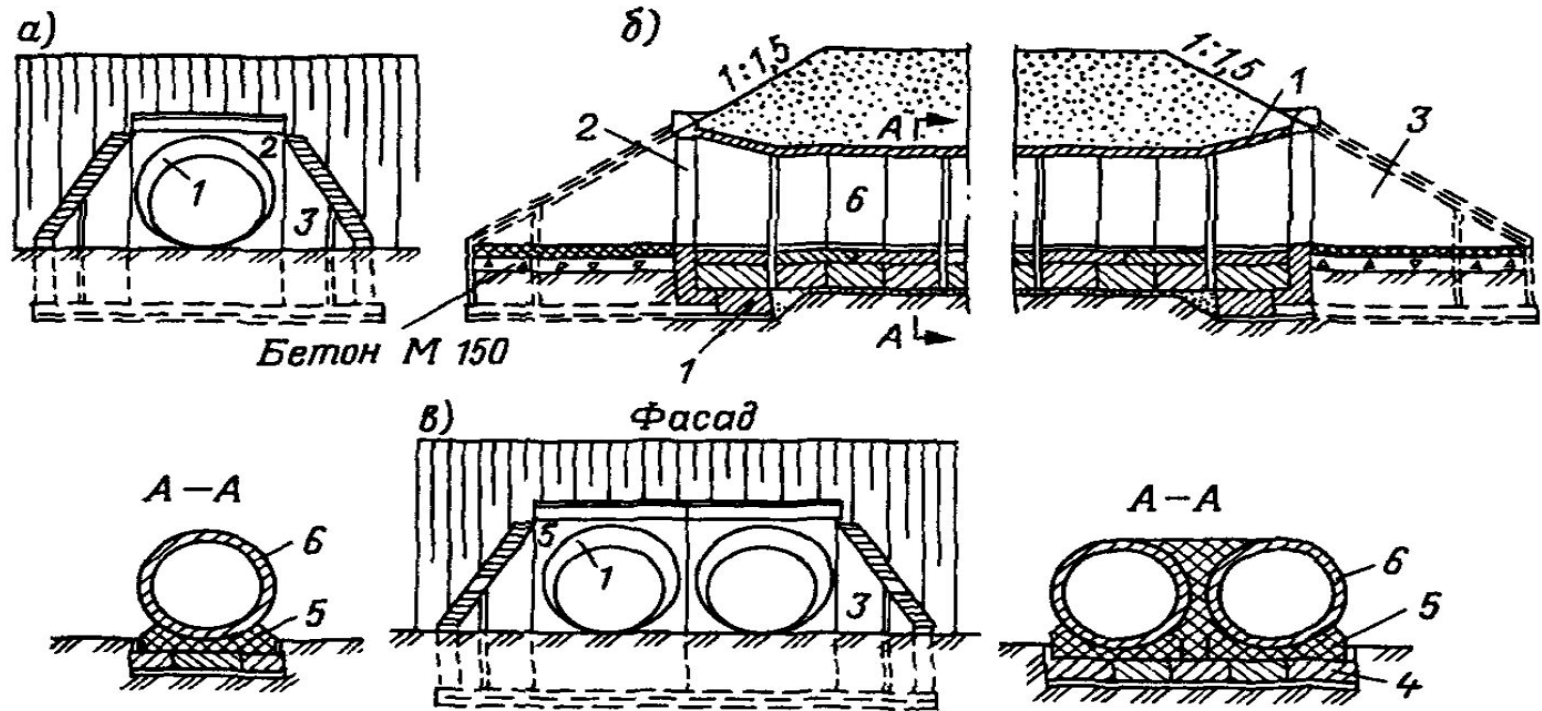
Схемы унифицированной сборной водопропускной круглой трубы:
